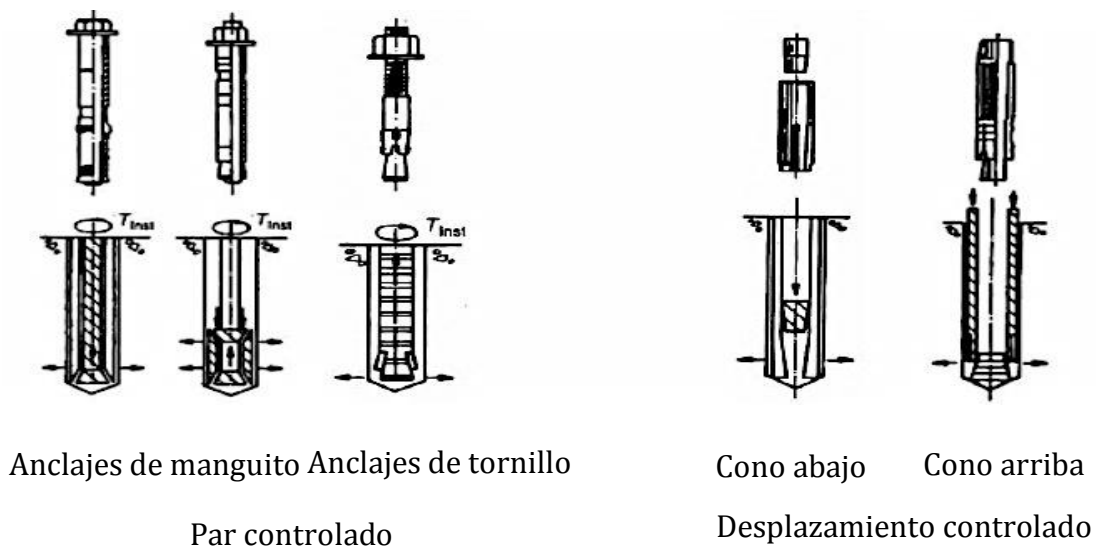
Anclajes de expansión mecánica (Eligehausen et al. 2006) (10).
